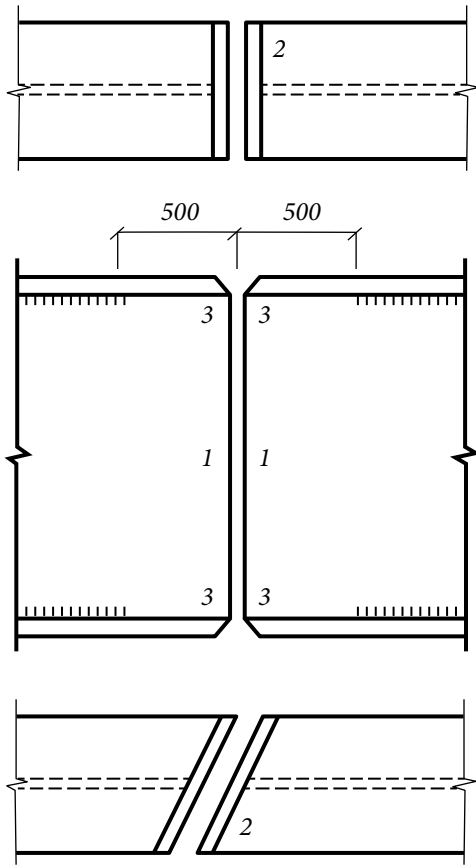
Монтажный стык составной балки на сварке
